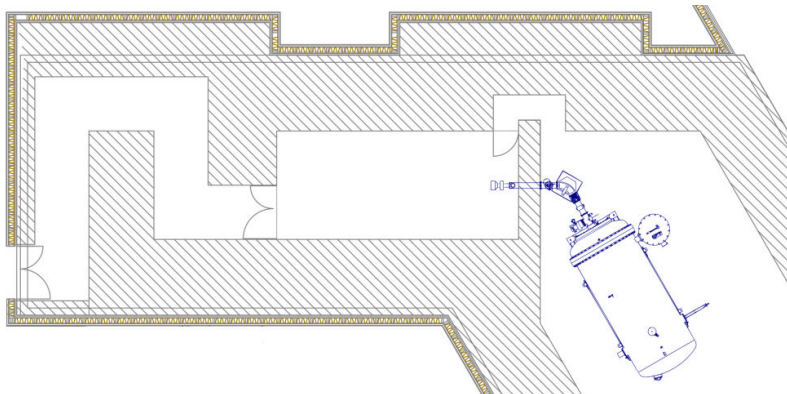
Plan de la salle d'irradiation (centre) et de la salle accélérateur (droite)
